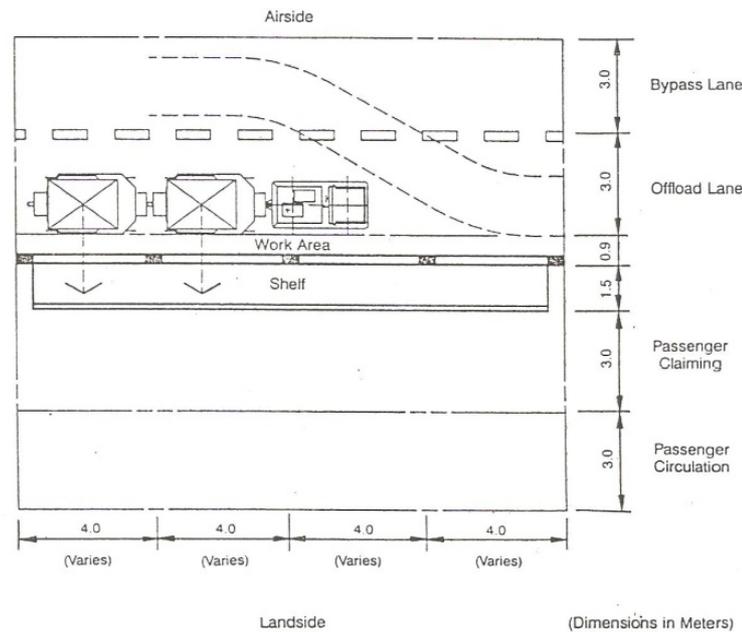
Planta: área de descarga e restituição de bagagem por prateleira
